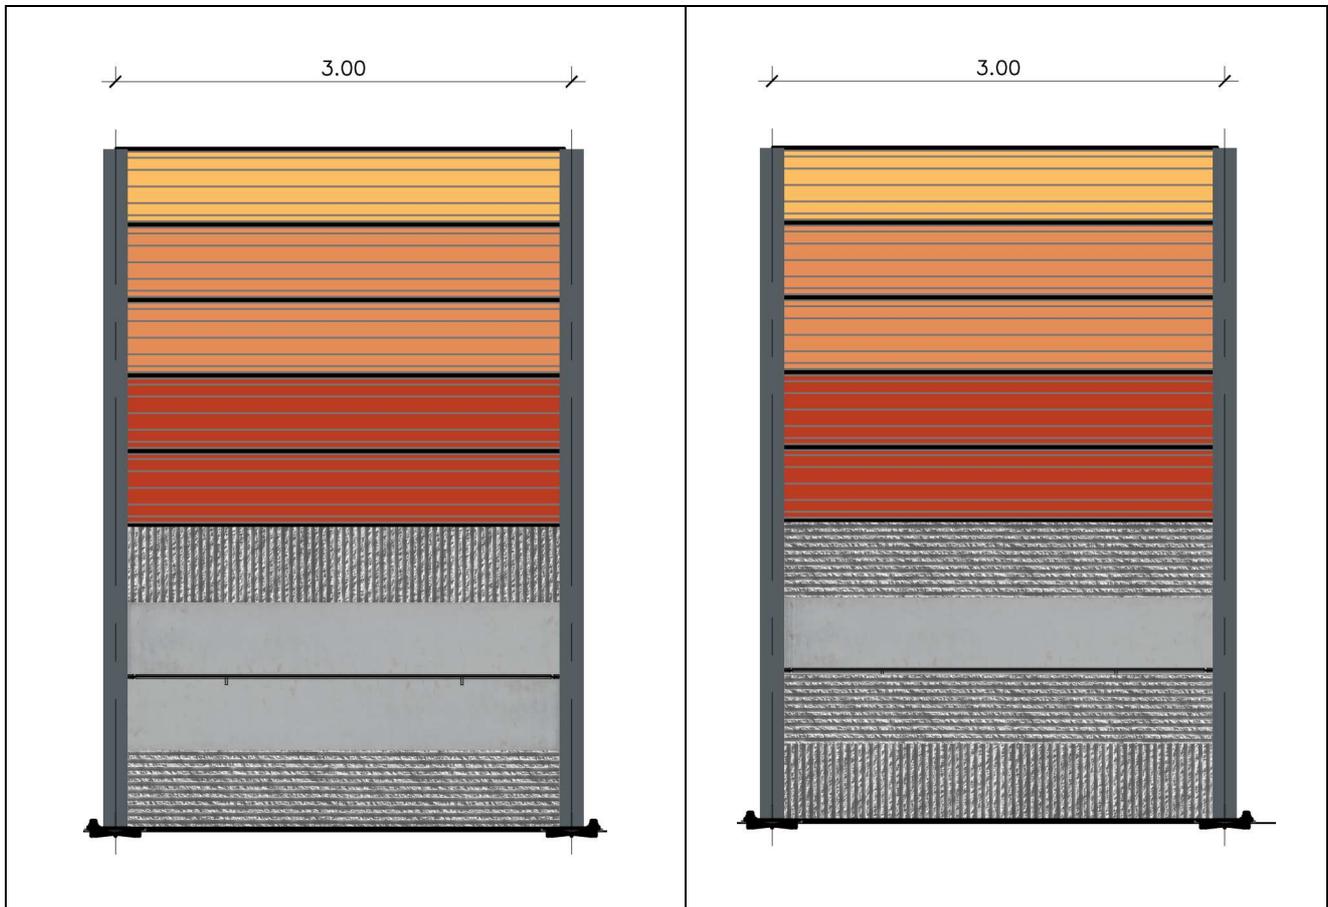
Prospetto Barriera lato esterno – uso di matrici
